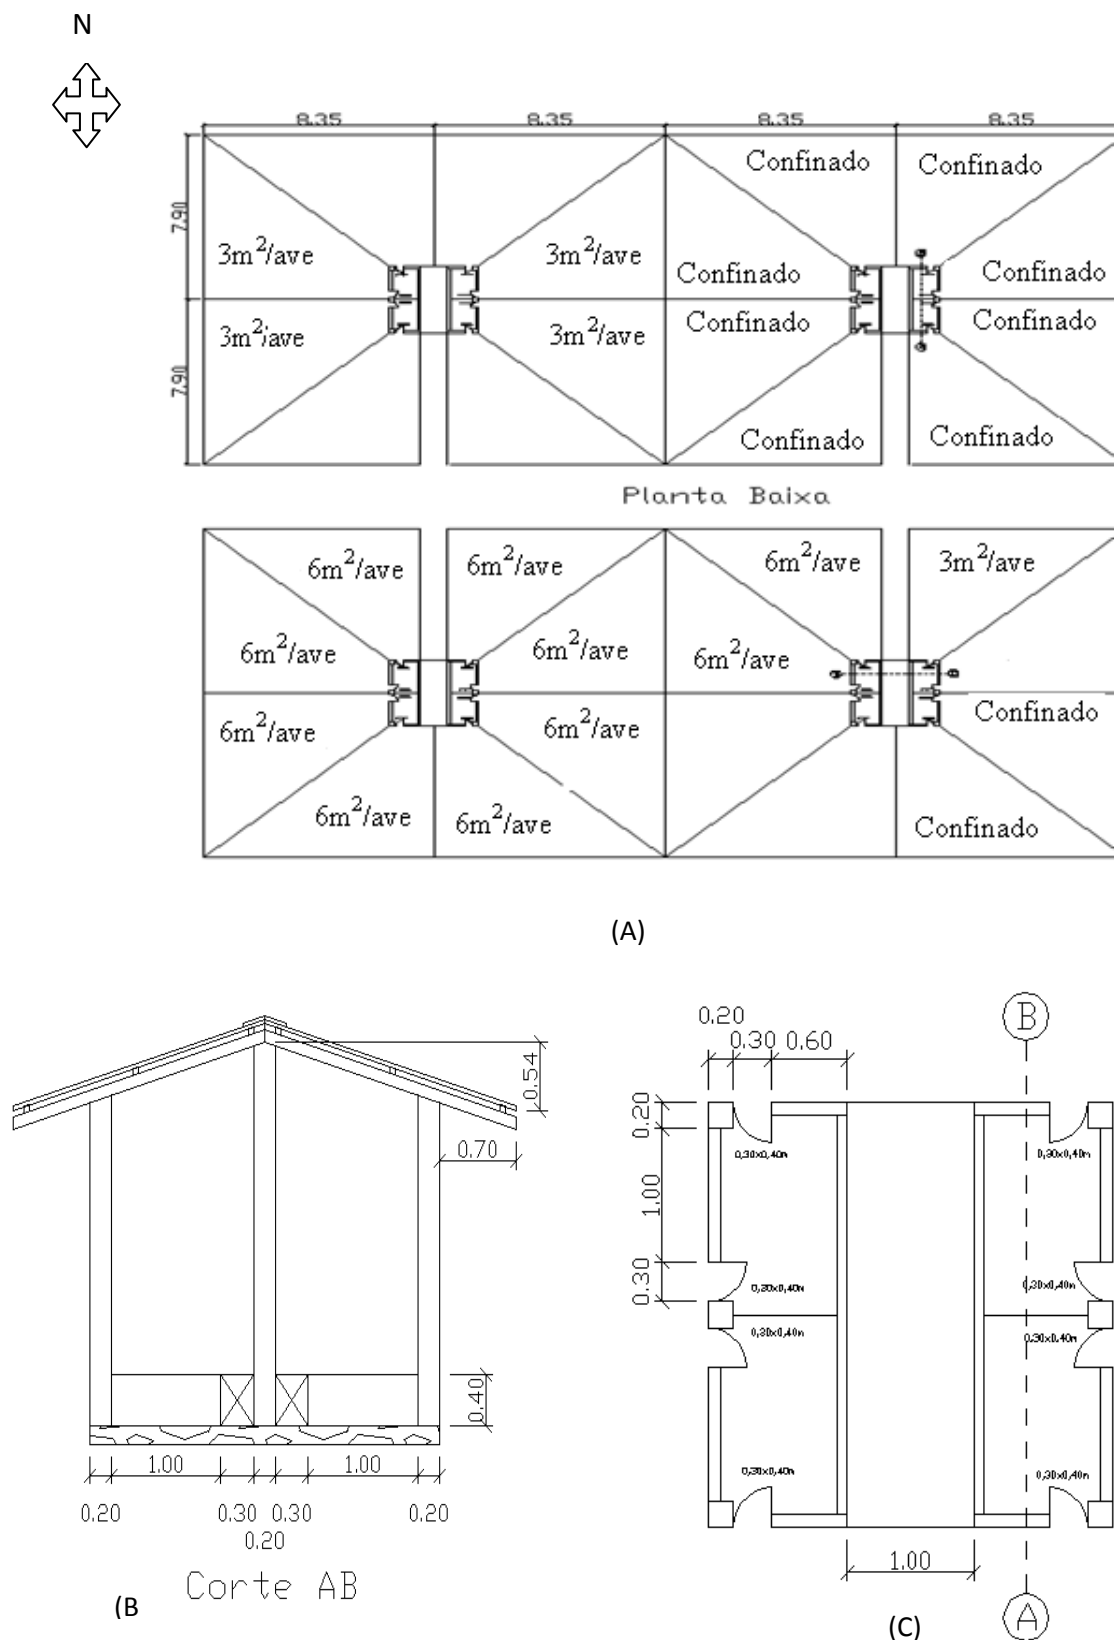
Planta de orientação dos piquetes (A) corte AB do módulo de produção (B) e planta baixa do módulo e a divisão dos boxes (C).
